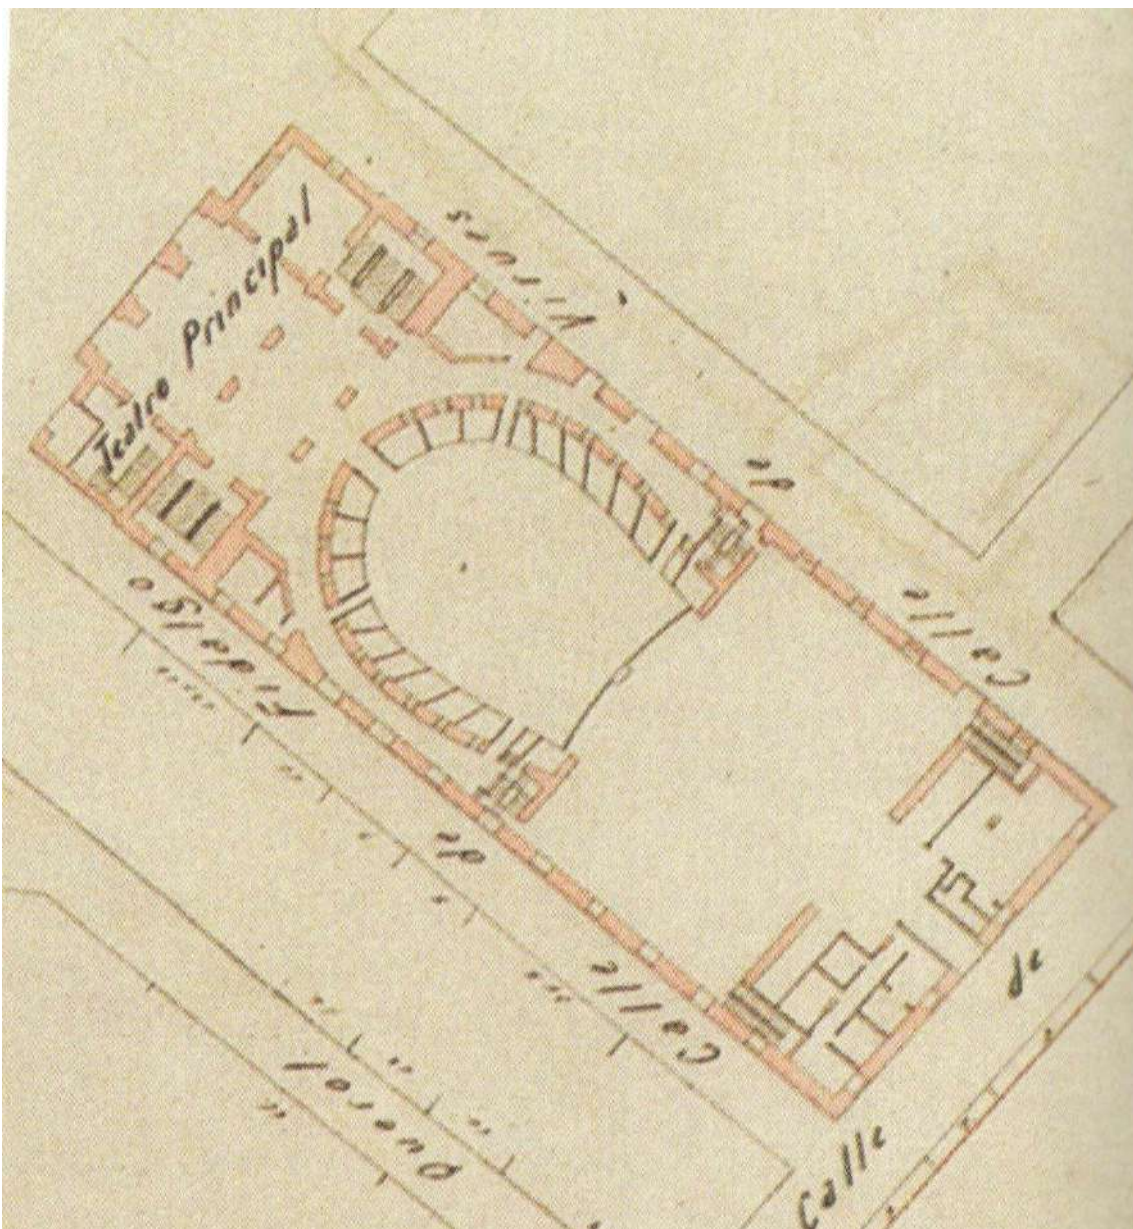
Plano de la planta esquemática donde se observa la forma en herradura.
